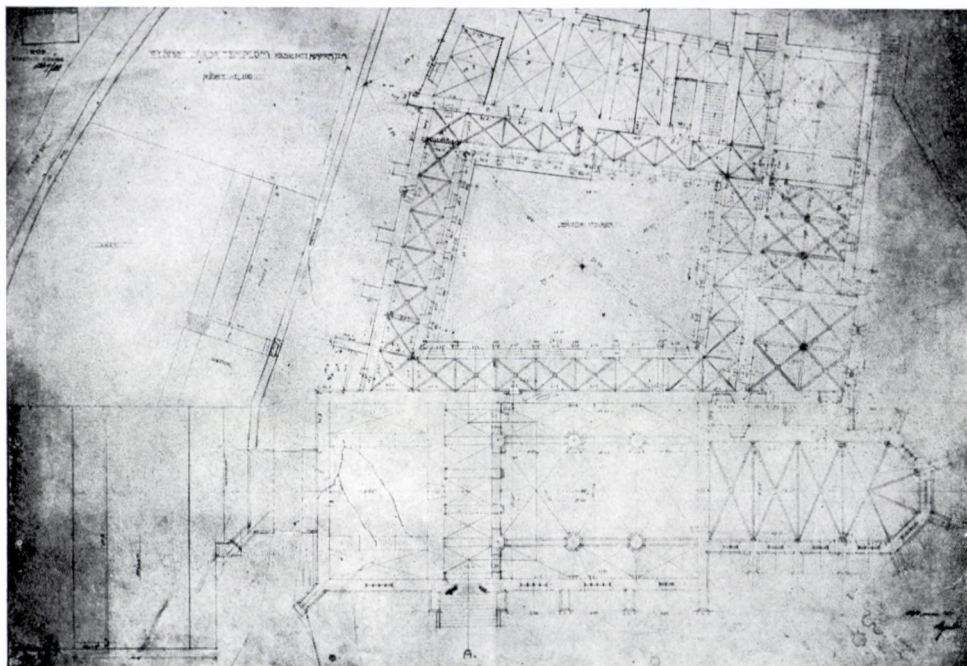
Kirche und Kreuzgang. Grundriß, Erdgeschoß. OMF
